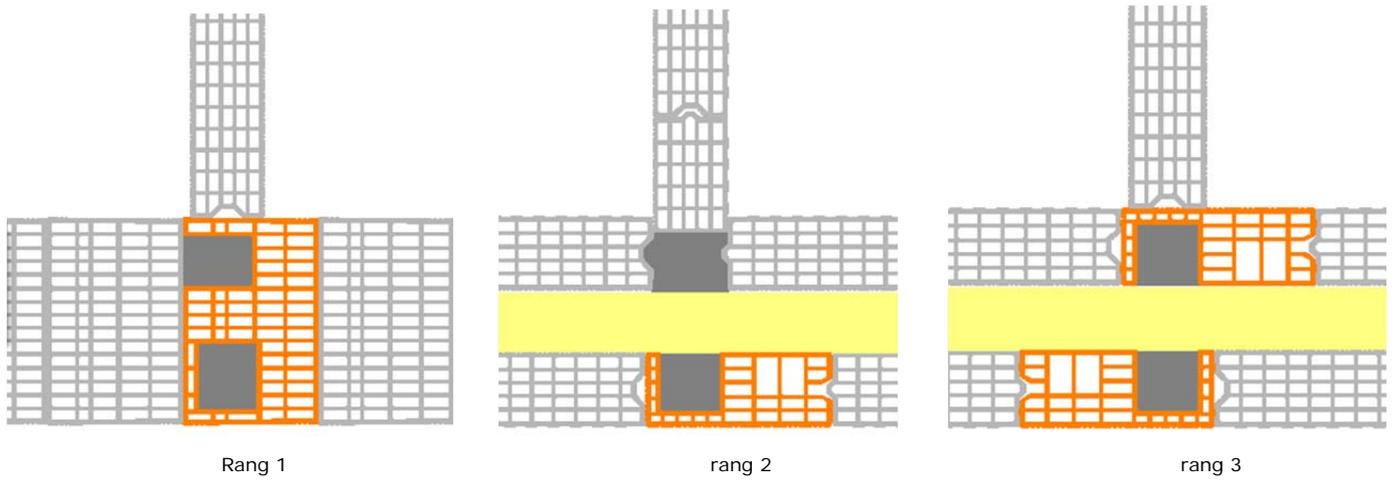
Jonction refend ép. 15cm/ Façade avec chaînages verticaux
